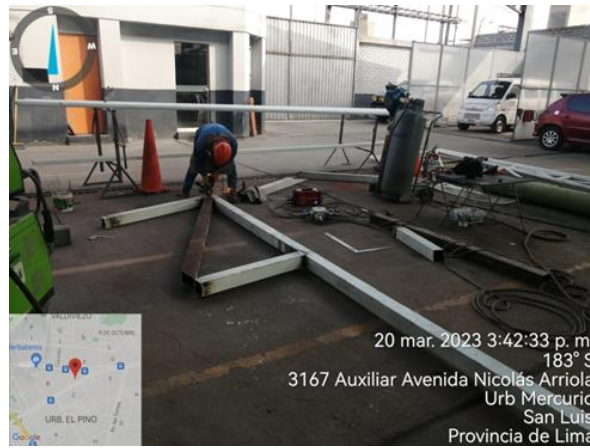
Armado de apoyos de columna. Fuente: *Elaboración Propia.
